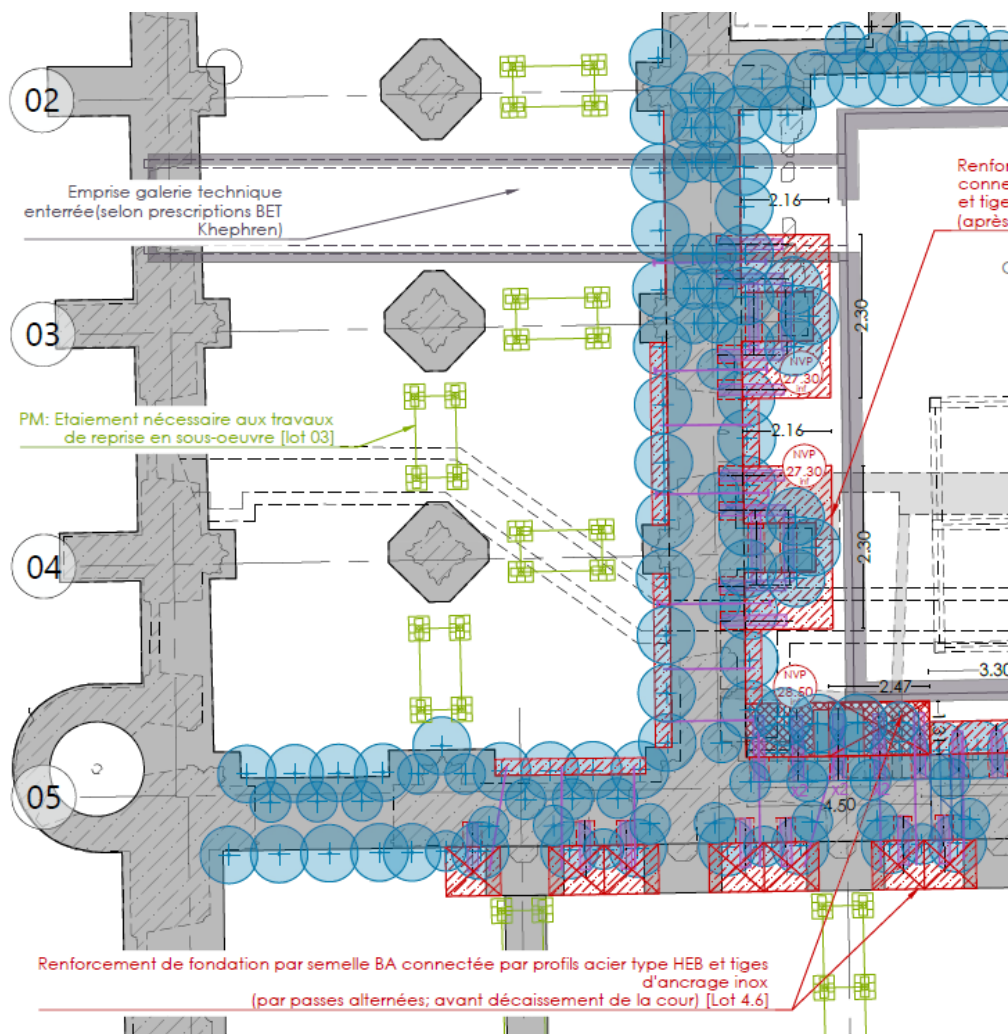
Plan de principe de l'implantation des colonnes de jet grouting au droit de la façade Sud (Conciergerie)
